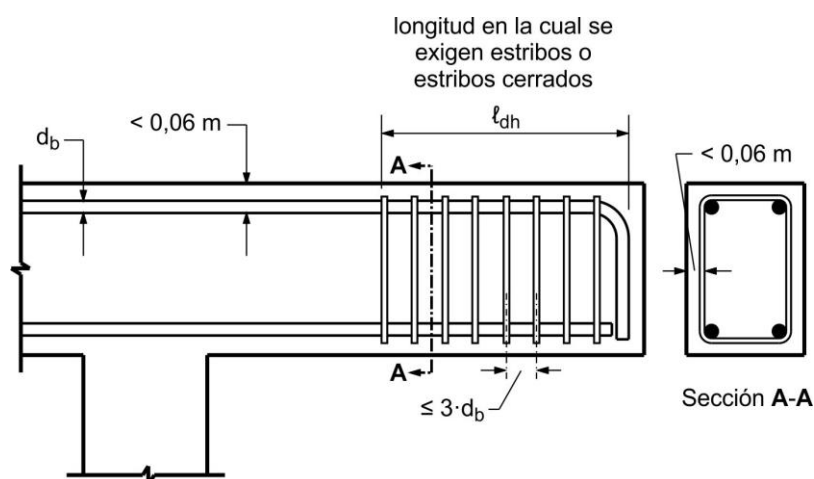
Estribos para las barras terminadas en gancho
